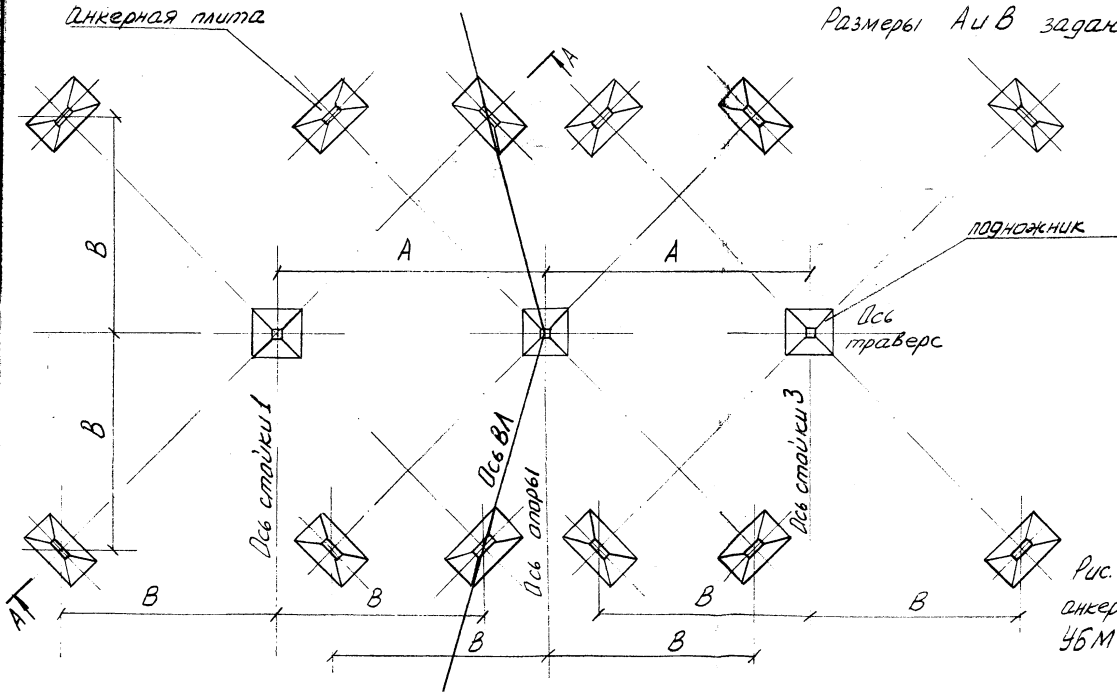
Схема фундаментов под анкерно-угловые опоры УБМ-17 и УБМ-22.
